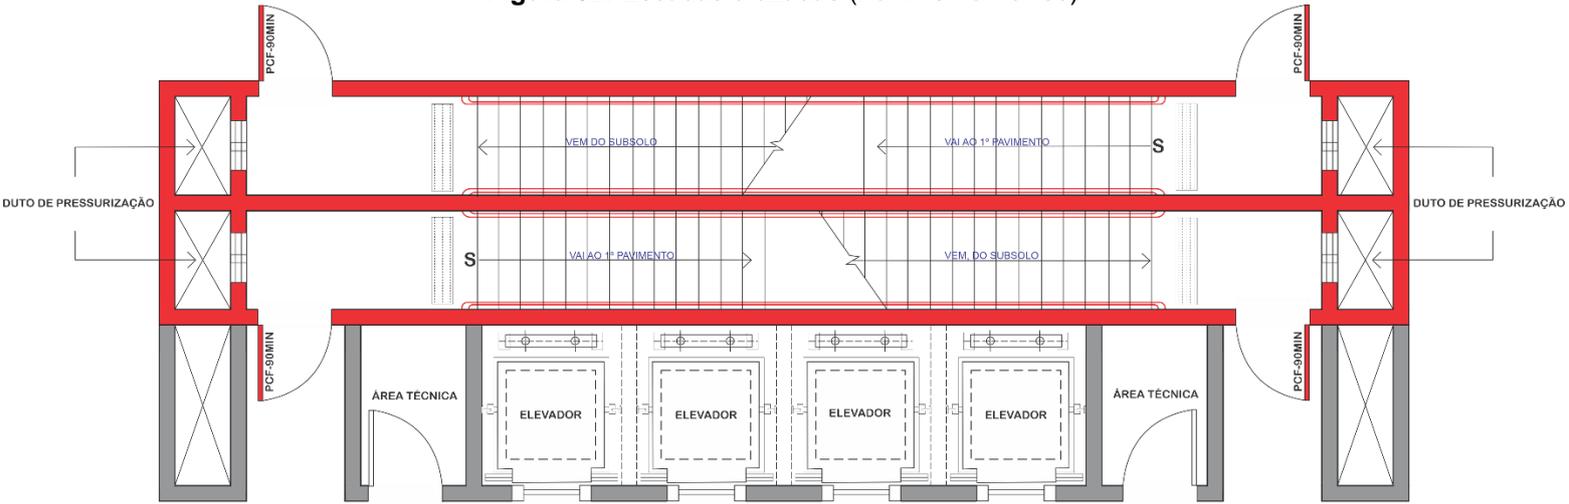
Escadas cruzadas (Pavimento Intermediário)
